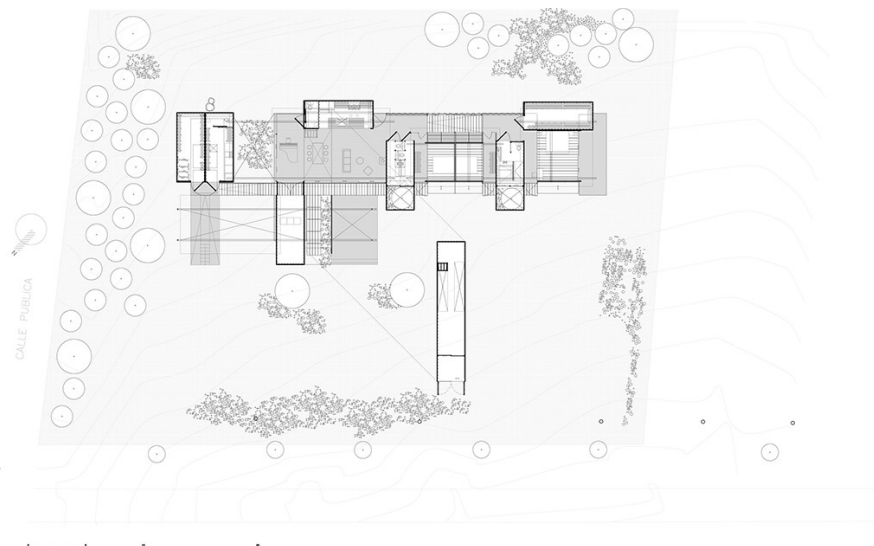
Planta Arquitectónica del Proyecto RDP
